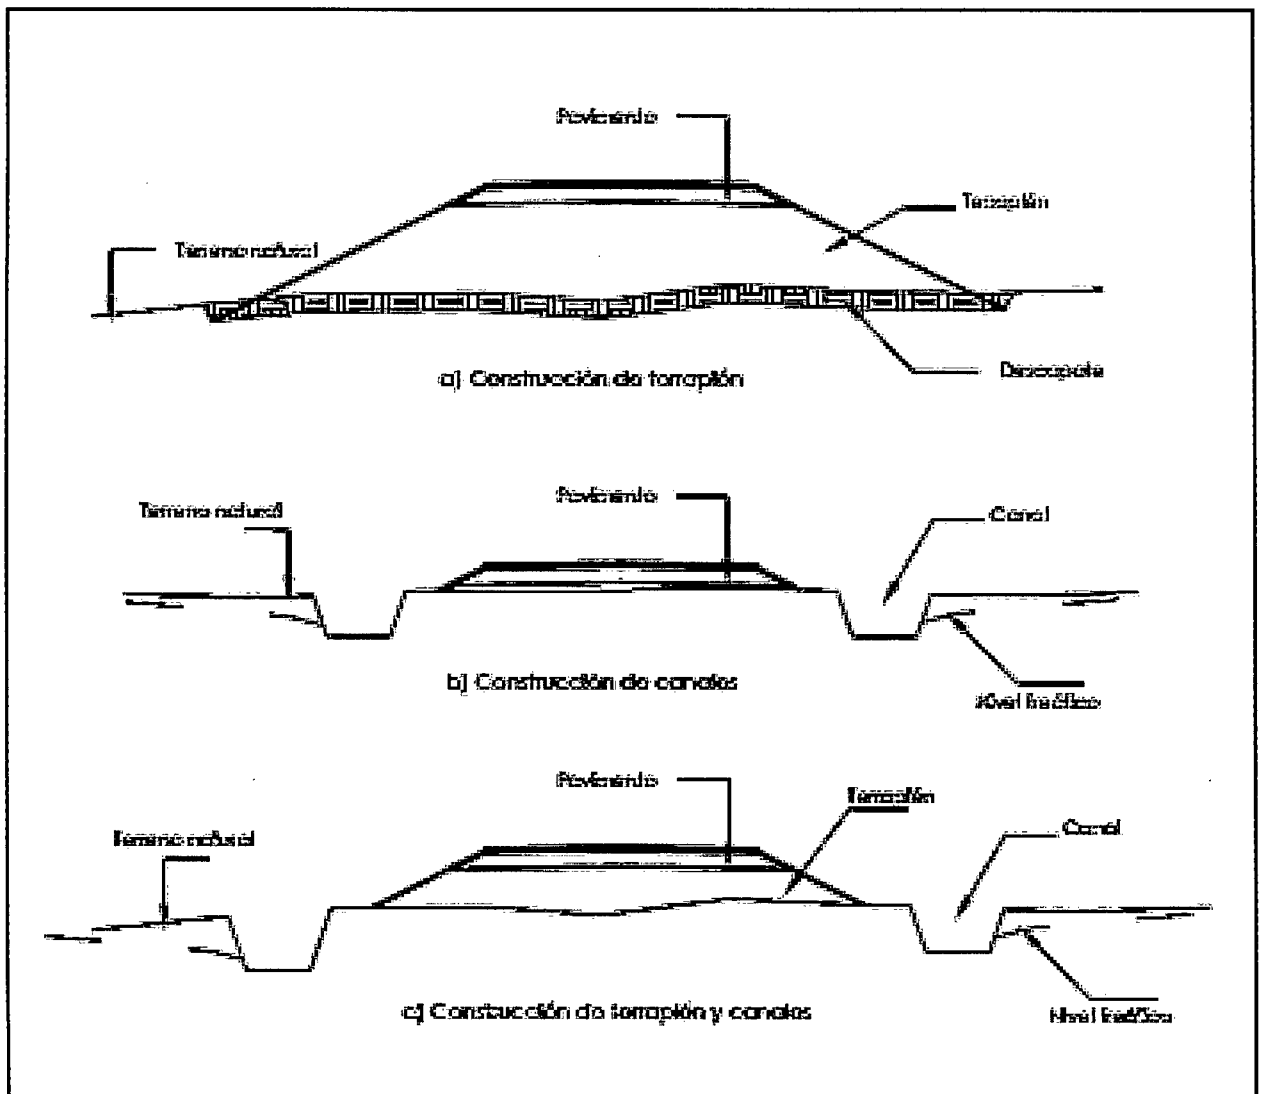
Construcción de carretera terreno Plano (Agudelo, 2002).
